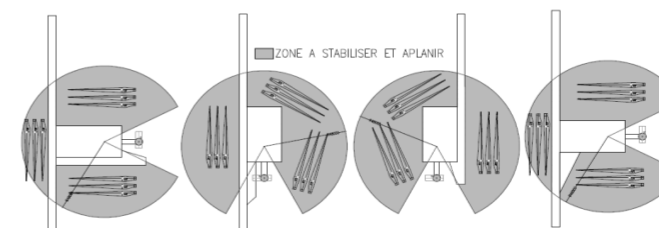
& tableau 2 : Exemples de stockages et dimensions
